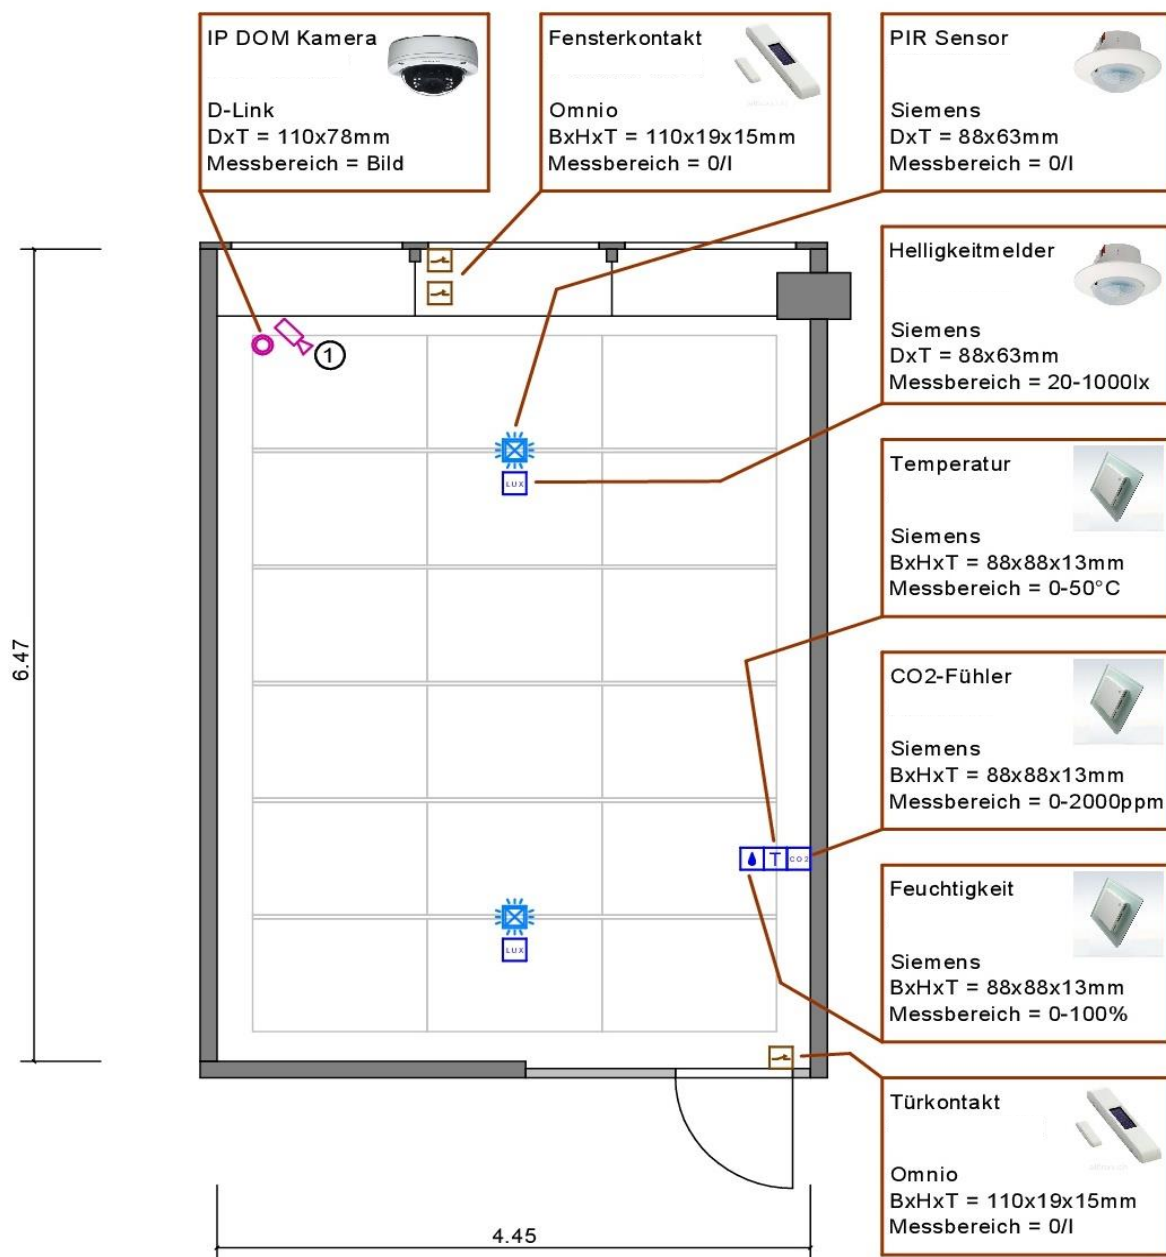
Grundriss des Sitzungszimmers C401b mit bestehenden Raumsensoren (Masseinheit: Meter). Bild: Hochschule Luzern.
